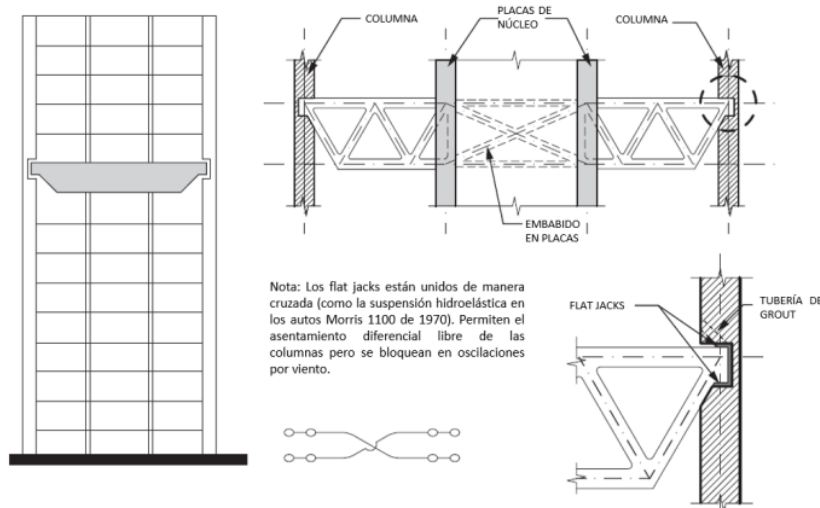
Sistema Cross-Jack de outriggers (Choi et al, 2012, p.40)
